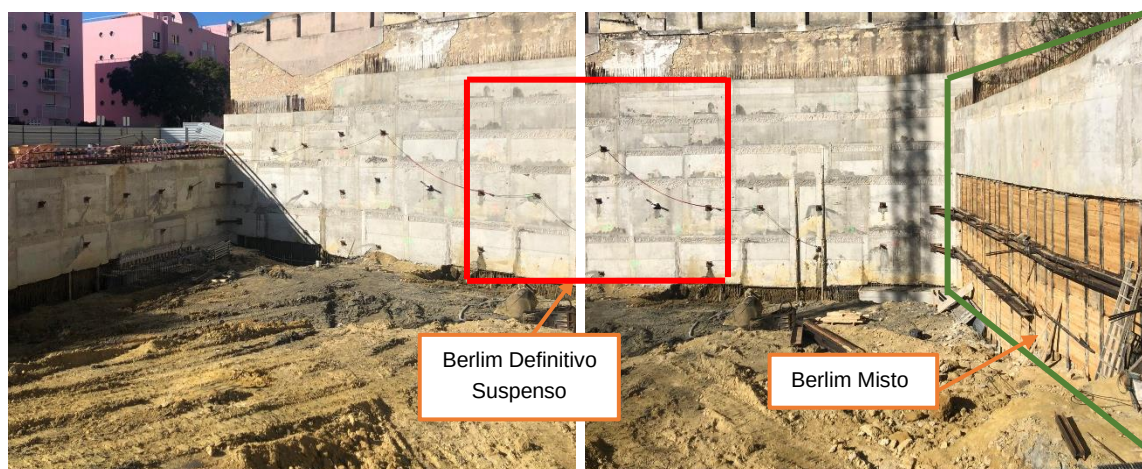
Vista dos trabalhos de chegada ao fundo de escavação – Lote 1
